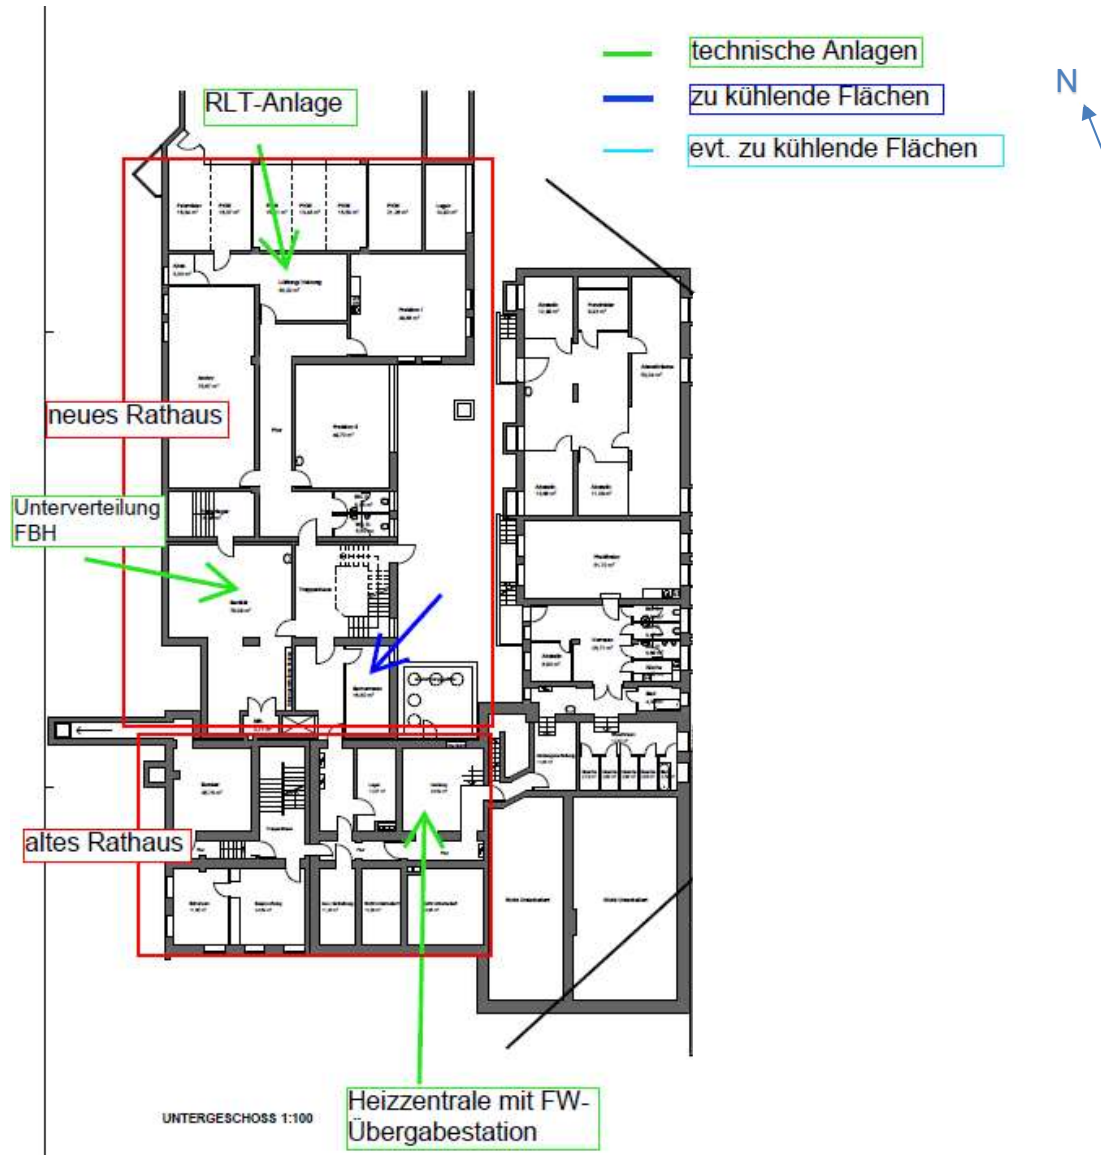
Rathaus Pullach, Grundriss Untergeschoss
